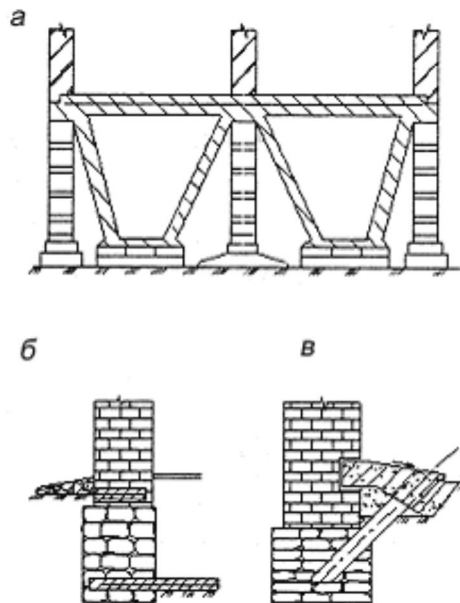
Удосконалені методи підсилення фундаментів на основі традиційних:
